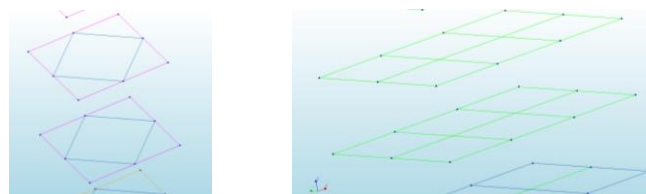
Detalle estribos de columna, modelos LS y VR
